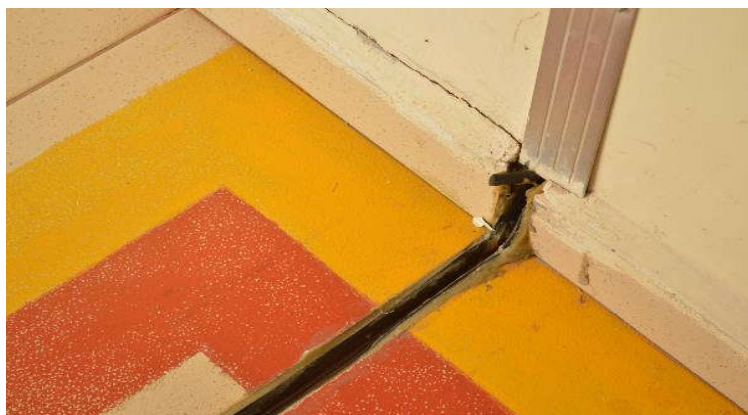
Nas paredes, as juntas possuem um acabamento em perfil metálico de alumínio.
